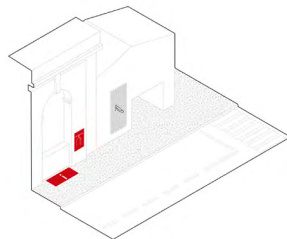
Placa de recorrido instalada en el pavimento. [Santiago de Compostela, España]
